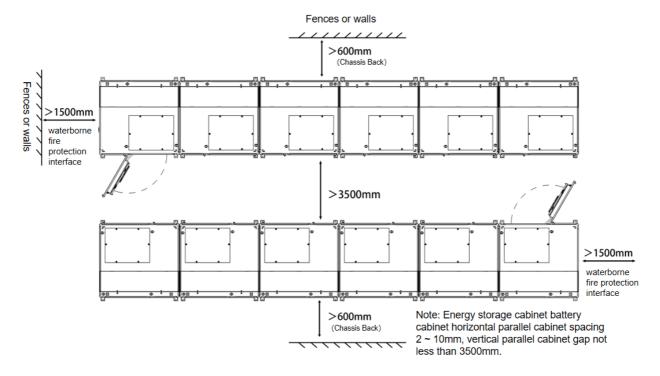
Installazione armadio in parallelo per Armadio di accumulo (fronte a fronte)
